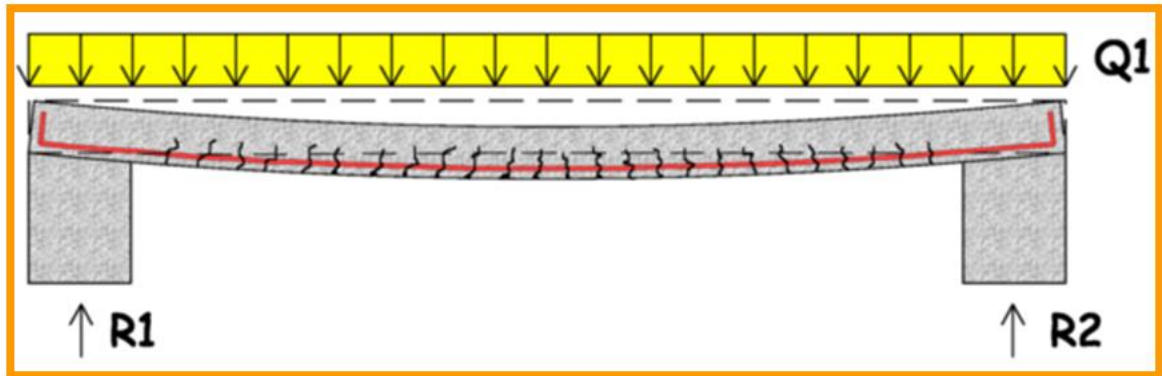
Viga bi apoiada com armadura passiva (Autora, 2015)
